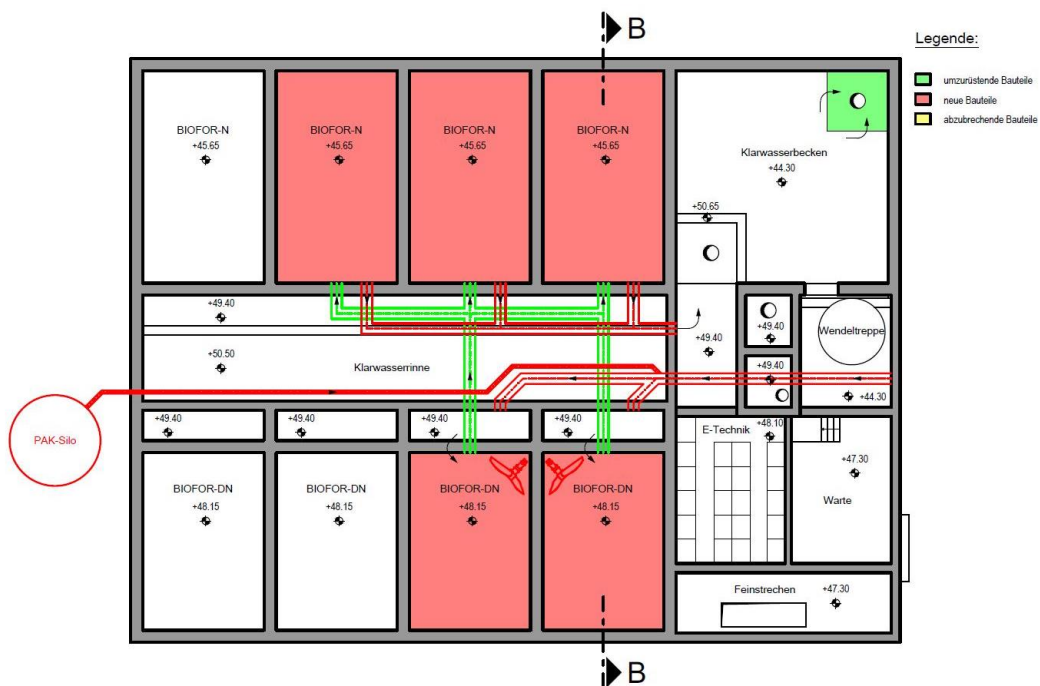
Umsetzung der Variante 1 auf der Kläranlage Vlotho – Grundriss
